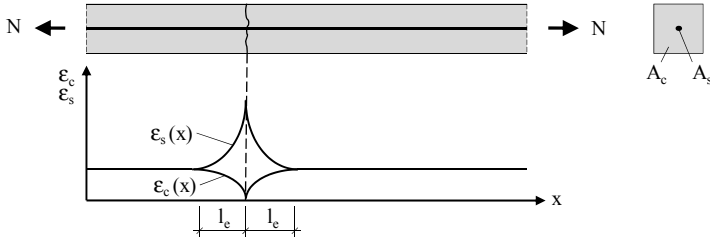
Dehnungen im Stahlbetonzugstab bei der Erstrissbildung
